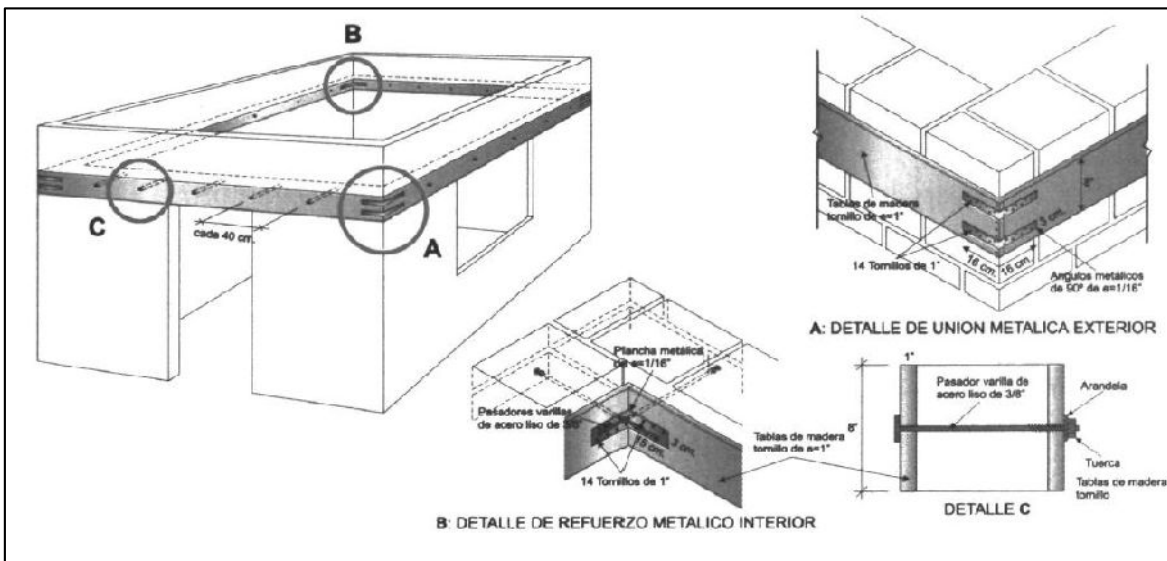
Viga collar CSK de madera y uniones metálicas (Kuroiwa 2002).
